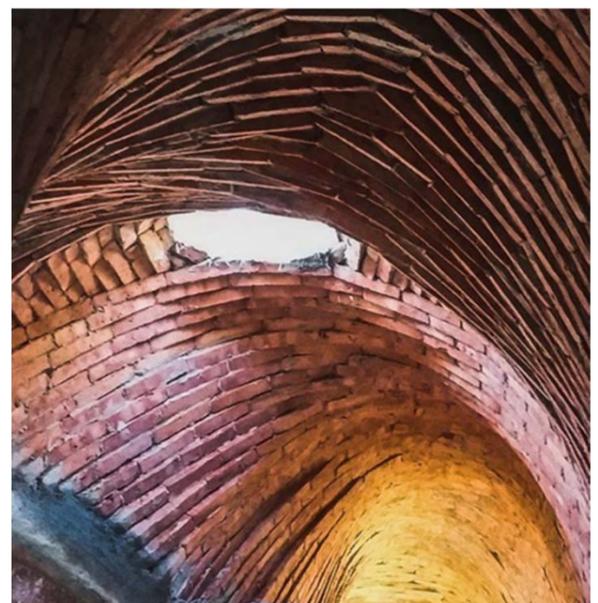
Vista Interior | Fuente: "Debarro Arquitectura"
